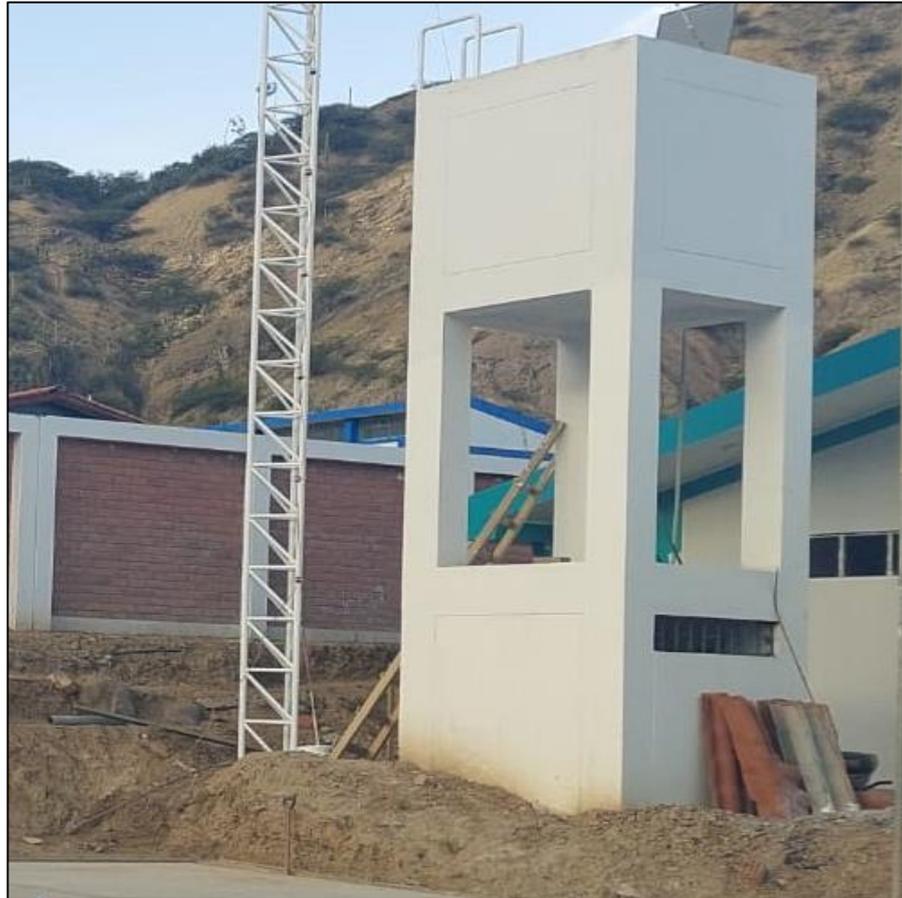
TANQUE ELEVADO Y CISTERNA
